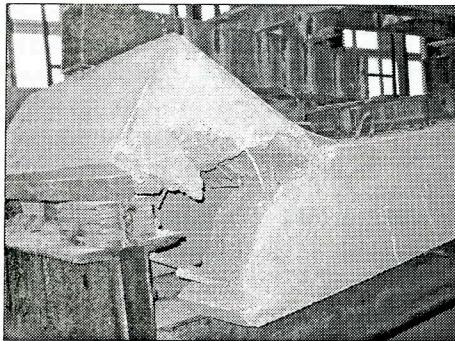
Плита № 1 без усиления, пролет 5,2 м. Разрушение в опорной зоне от действия поперечной силы
